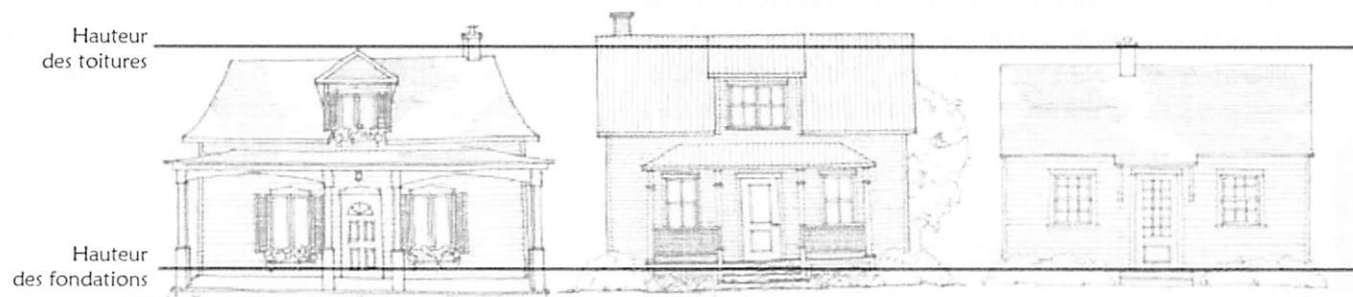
Exemple d'intégration d'un bâtiment principal en fonction de la hauteur du bâtiment et de la fondation. SOURCE: Service d'aide à la rénovation patrimoniale
